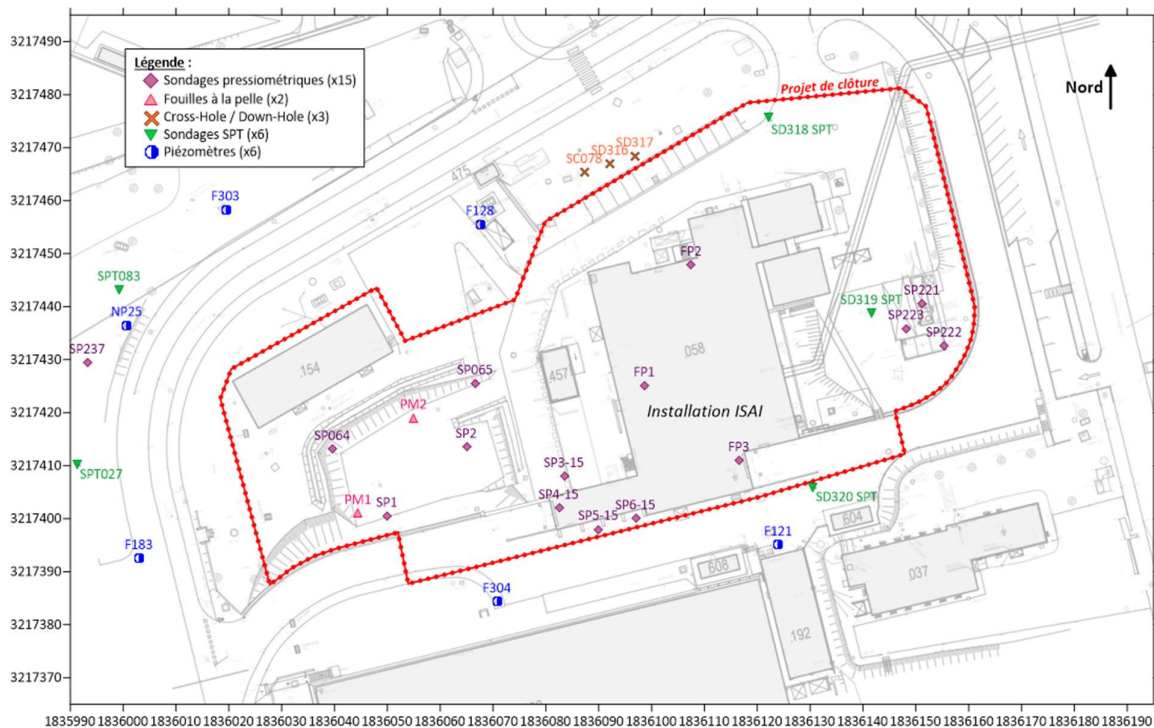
Plan d'implantation des sondages d'archives par type d'essai
